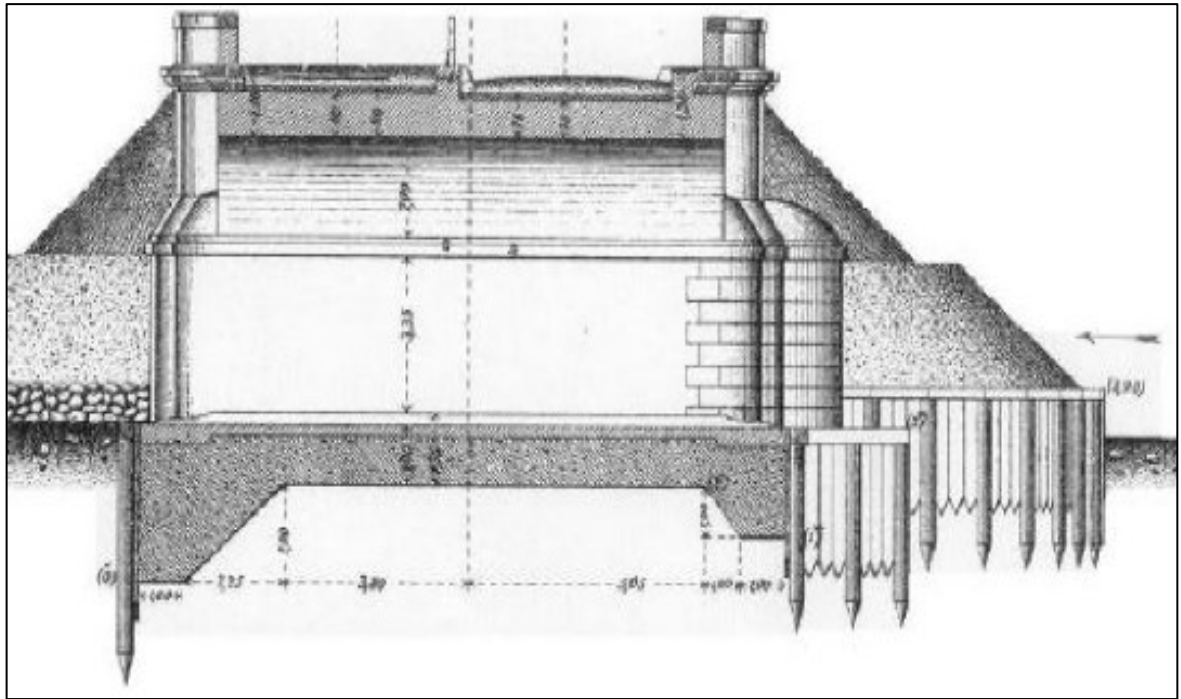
sezione trasversale di una fondazione. (Fonte: Solazzo, 2016)
